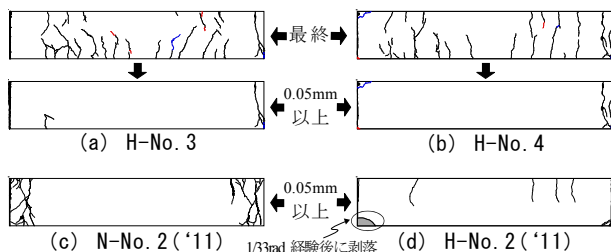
1/33rad. 経験後のひび割れと幅0.05mm以上のひび割れ
